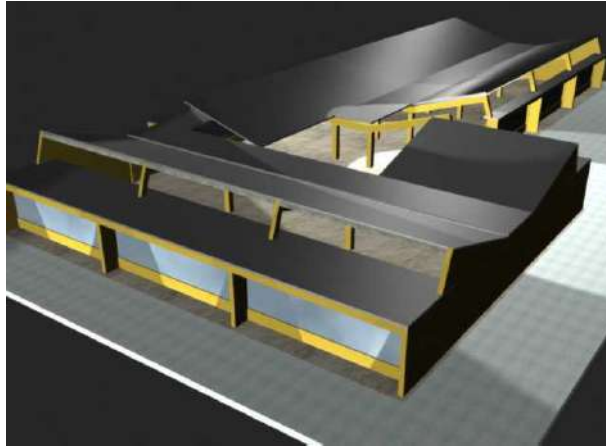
sistema constructivo membranas plegadas de ferro concreto moderno.
